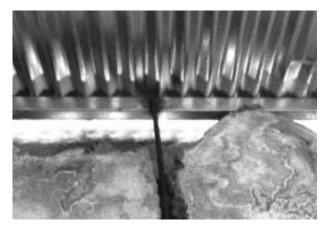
Solución técnica dada para la adaptación de purlings metálicos a viviendas de prefabricación ligera tipo NOVOA.
